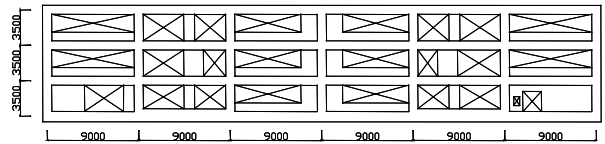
平面図及び鉛直部材の損傷度(単位:mm)
